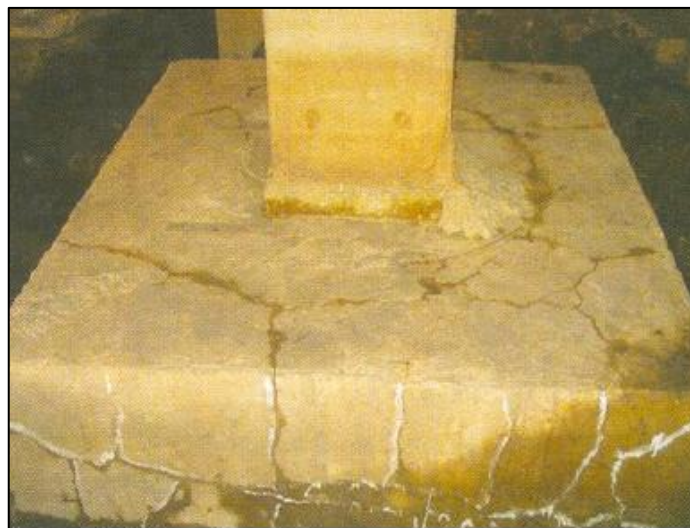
Mapeamento de fissuras em blocos de fundação devido a reação álcali-agregado. (Fonte: <<http://www.demc.ufmg.br/aquiar/Mecanismos%20de%20Deteriora%E7%E3o.pdf>> Acessado em 30/01/2012, às 14:35:29)
